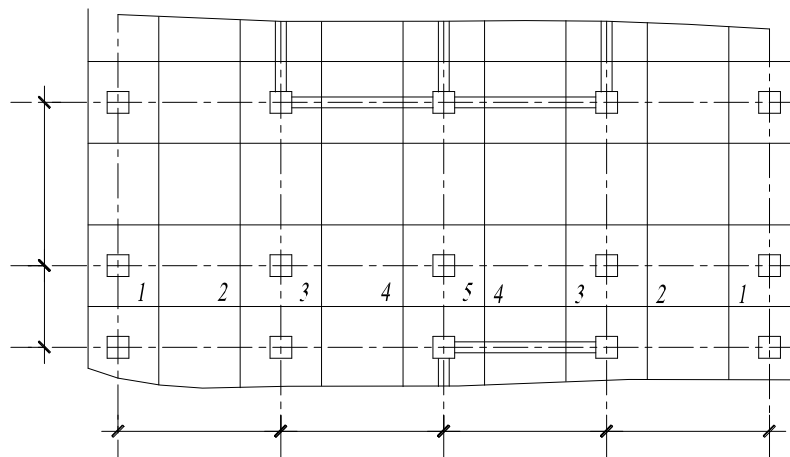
Схема расположения монолитных плит перекрытия
